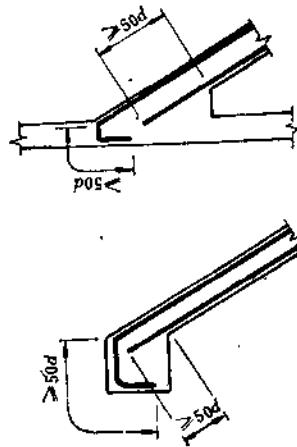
漏斗斜向钢筋锚固长度示意图
